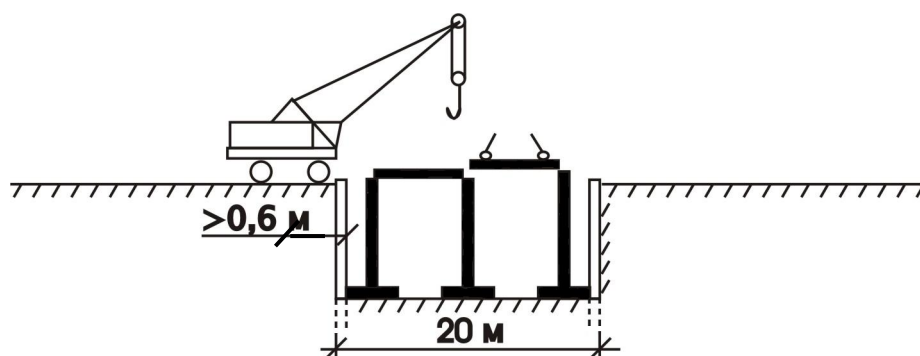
Организация работ в котловане с перемещением технических средств за пределами котлована с вертикальными откосами
